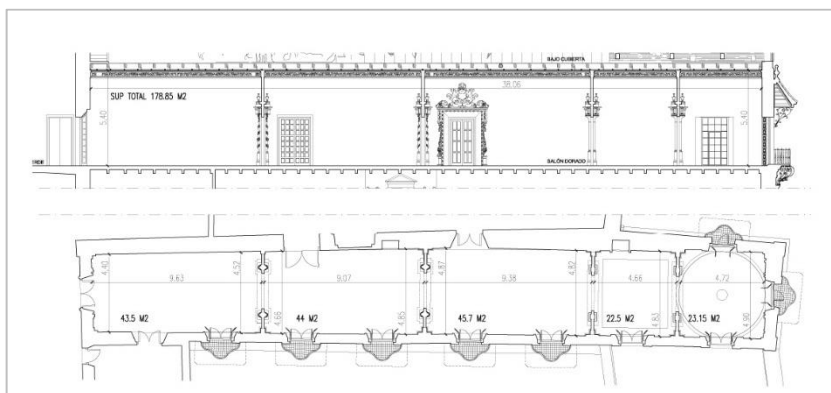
Planta y alzado de la Galería Dorada del Palau Ducal de Gandia.
